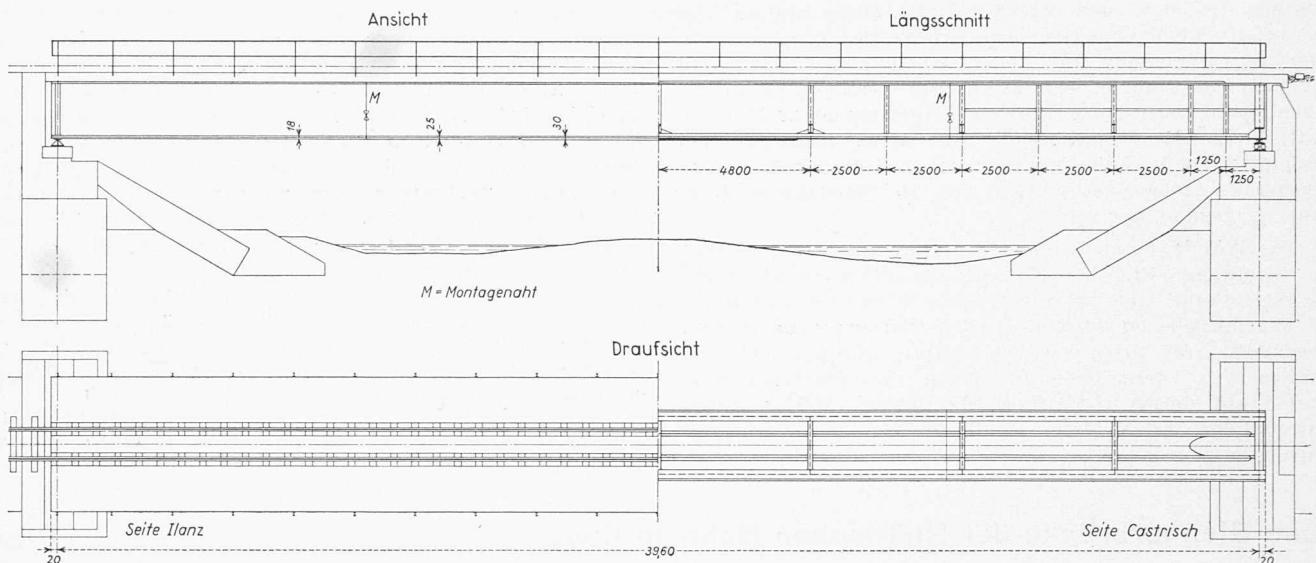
Neue Glennerbrücke, Grundriss, Ansicht, Längsschnitt und Horizontalschnitt 1:250
